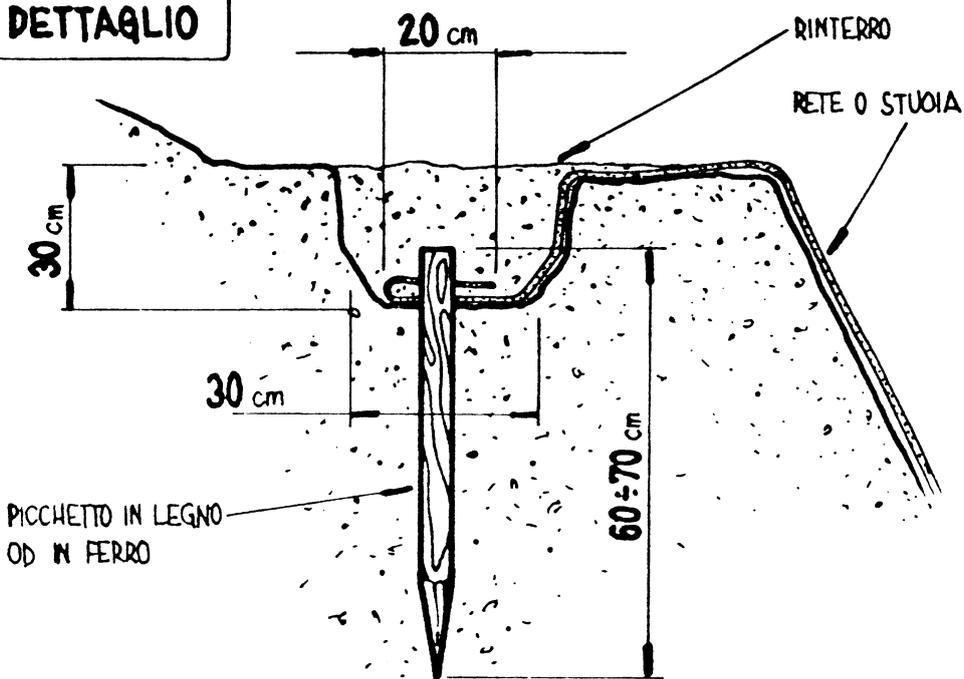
PROTEZIONE DI VERSANTI CON ELEMENTI ANTIEROSIVI E INERBIMENTO
